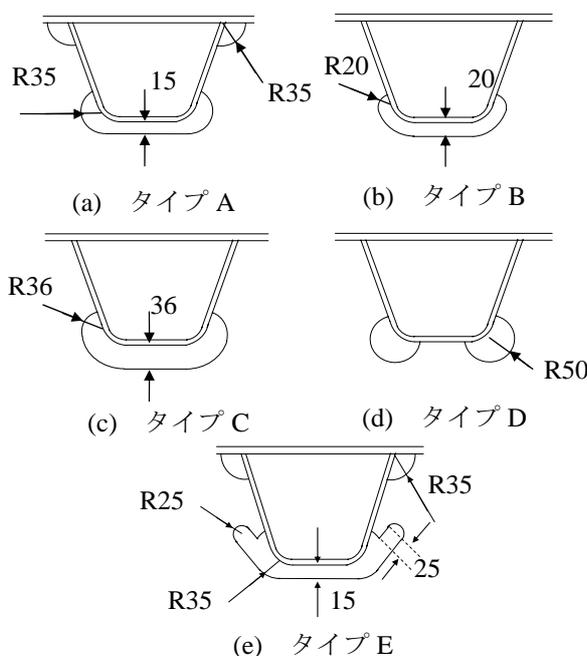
縦リブ横リブ交差部の詳細 (単位: mm)
